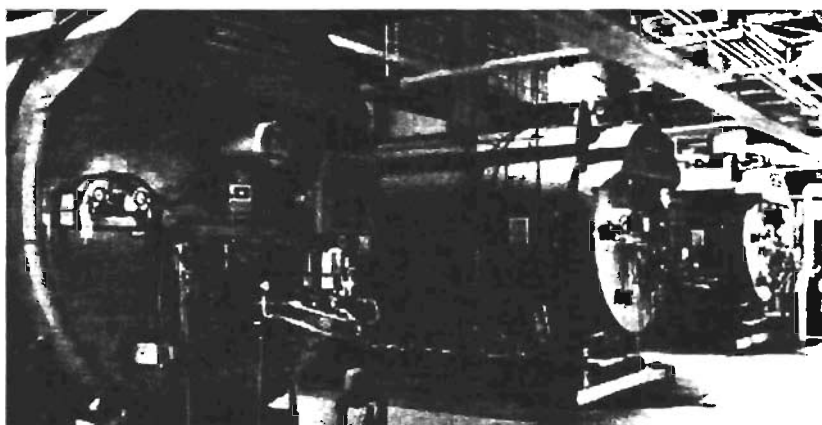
Vista de cuarto de calderas con equipos instalados en batería con un arreglo de conexión en paralelo.
